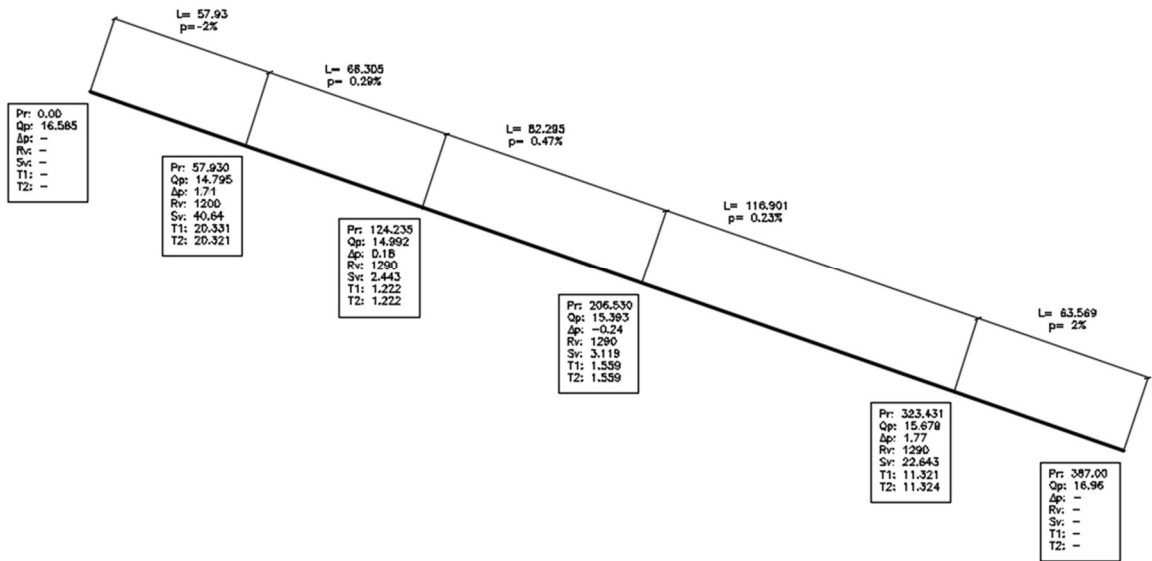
planimetria di tracciamento nuovo tronco stradale Via del Pino
